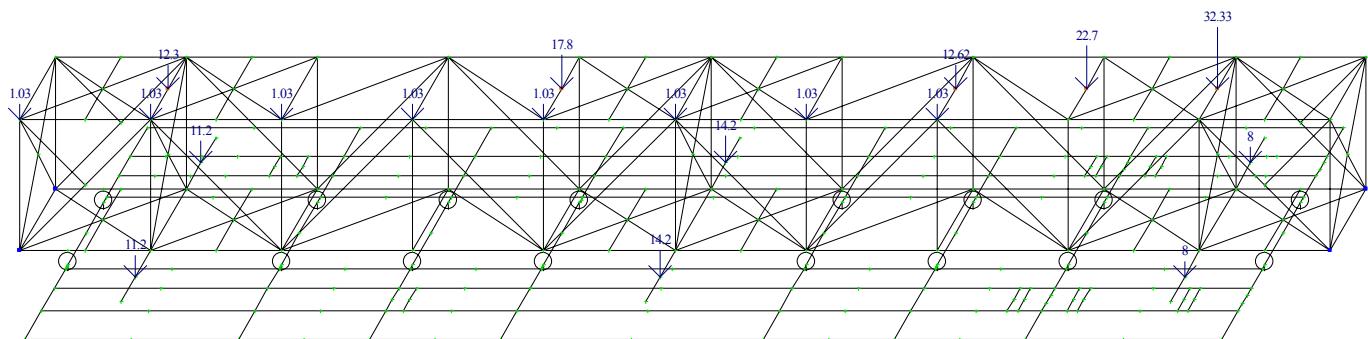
Вертикальные нагрузки от существующих трубопроводов и площадок
